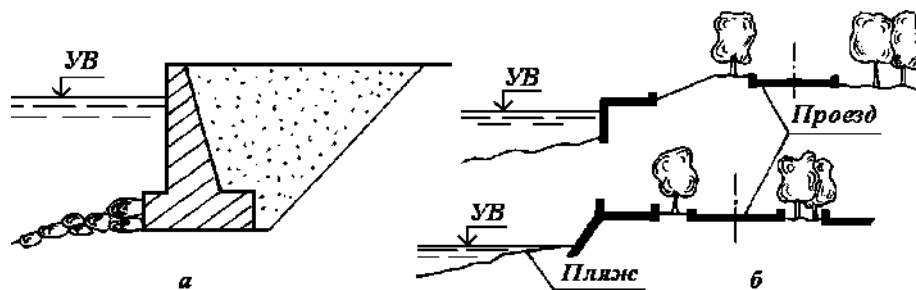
Конструкции береговых стенок: а — пример береговой подпорной бетонной стенки; б — примеры профилей речной набережной
